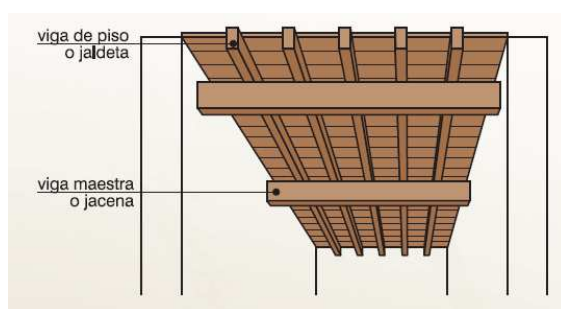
Forjado de piso de dos órdenes de vigas.
